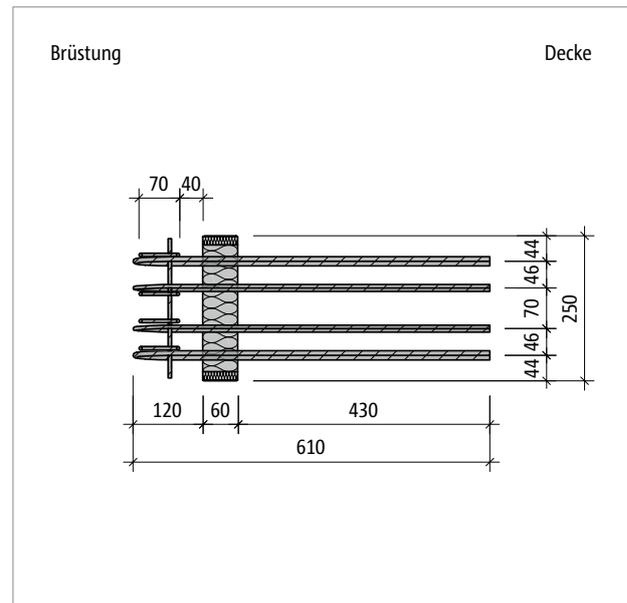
Schöck Isokorb® T Typ F-X60: Produktgrundriss
